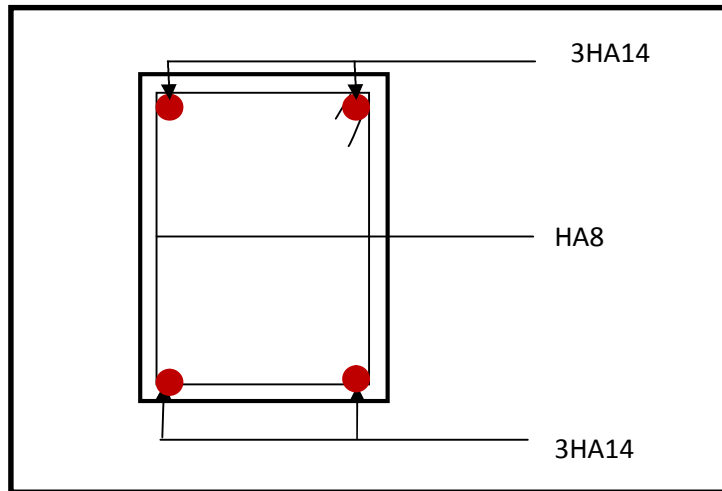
Figure.VI: Ferrailage en travée d'une poutre secondaireSur appuis :
